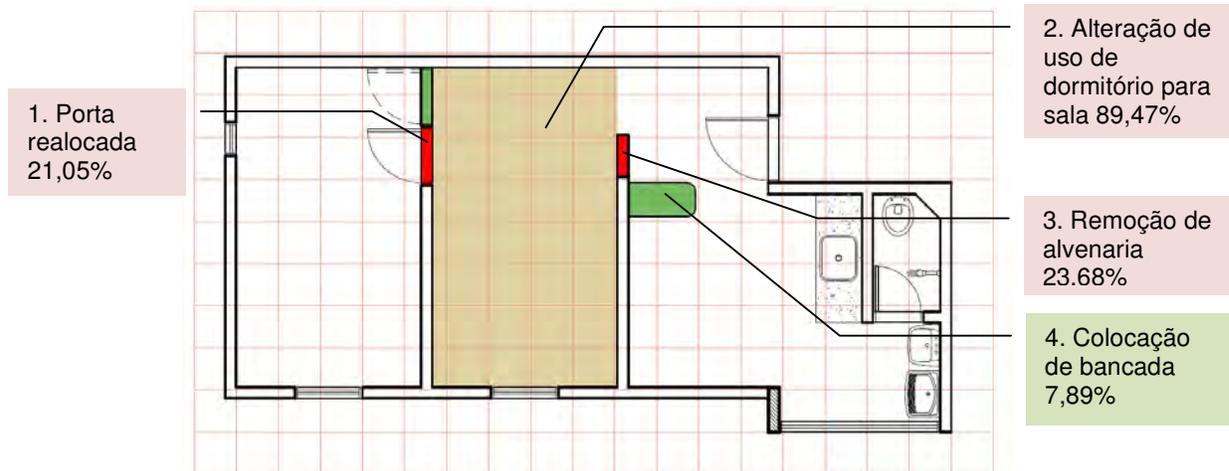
Planta *layout* executivo – modificação feita no projeto original.
